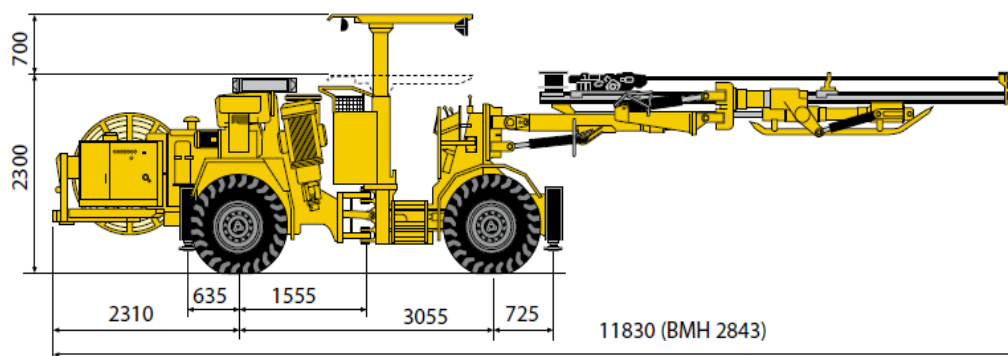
Atlas Copco Jumbo Boomer 282- Vista Lateral
